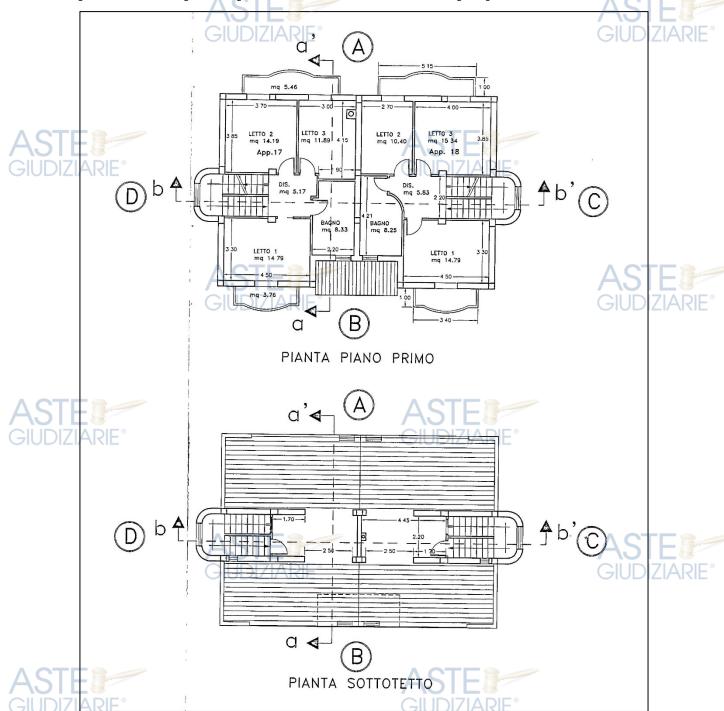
planimetrie progettuali approvate (P.primo e P.Sottotetto)
